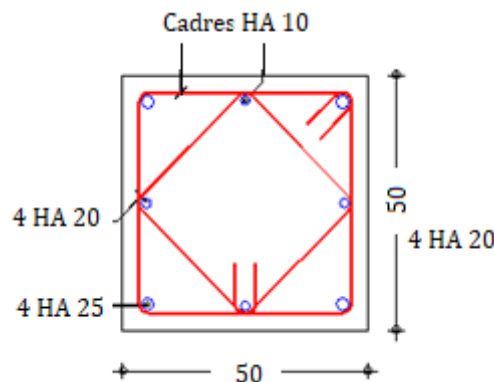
Ferrailage du poteau selon le CBA 93.
